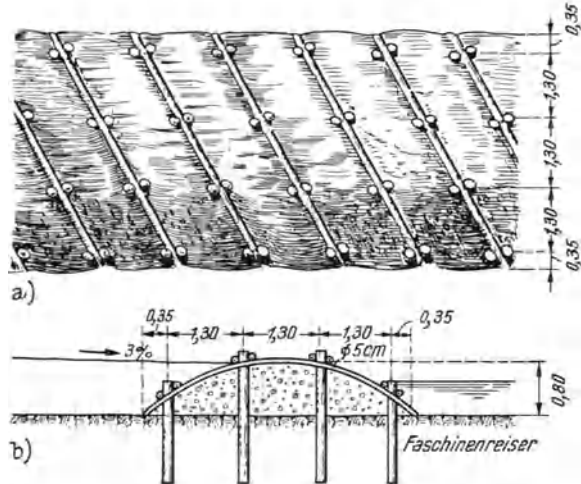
Faschinendamm. a) Draufsicht. b) Querschnitt.
